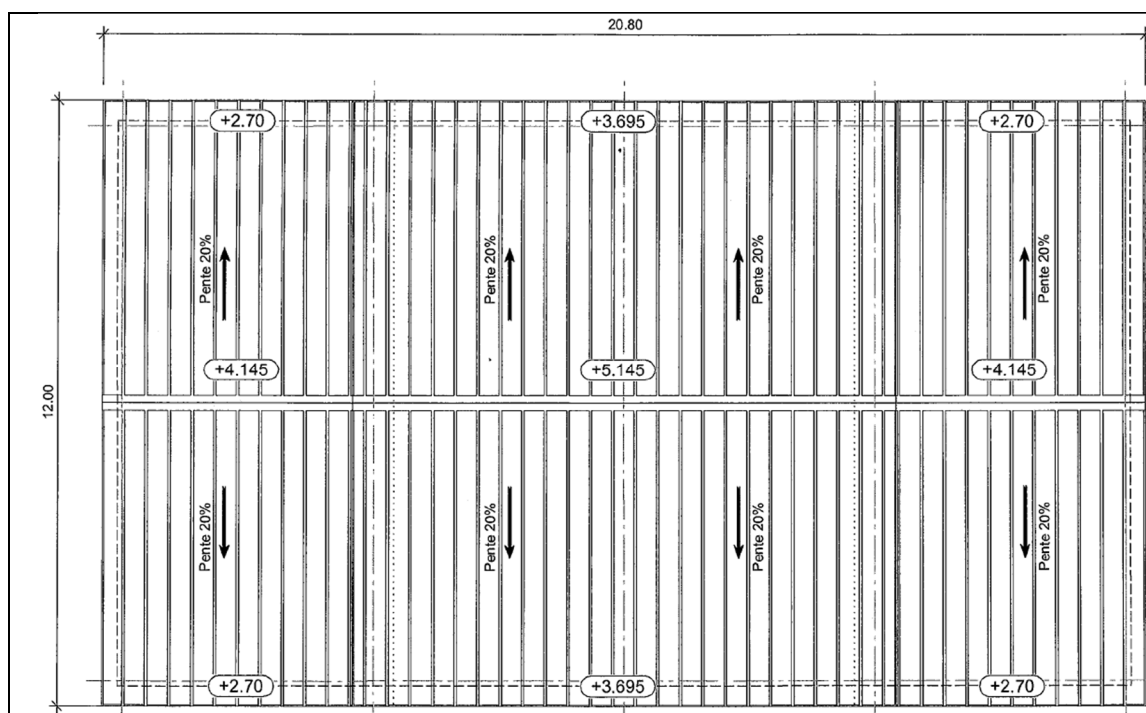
Plan de la toiture de l'abri couvert (espace SAPHIR)
